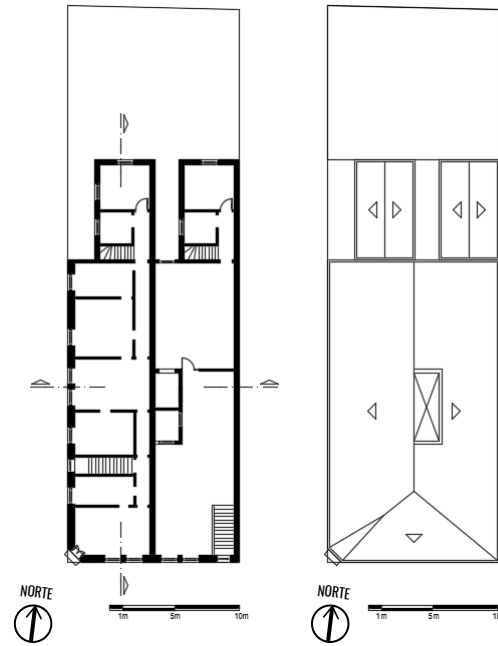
Planta Baixa do segundo pavimento (escala gráfica)
